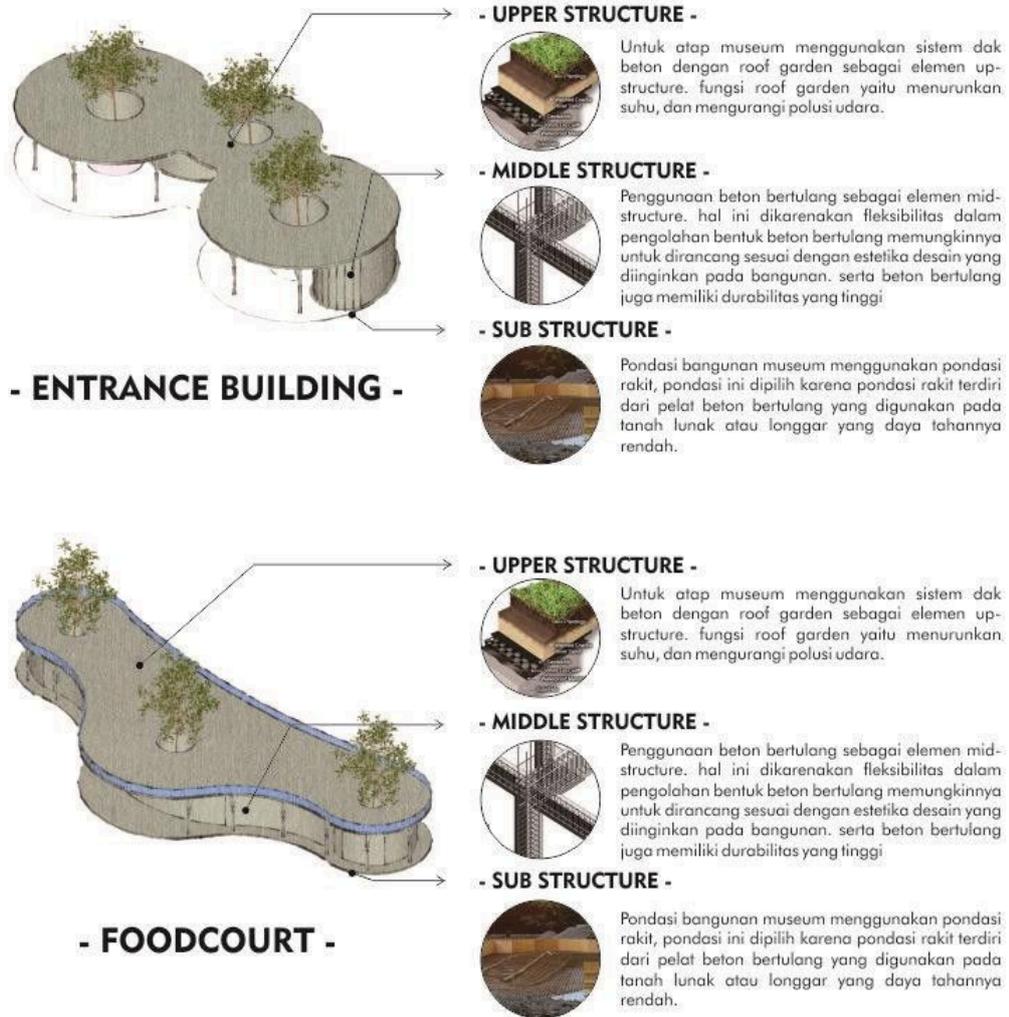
Analisis Struktur Bangunan Wedding Chapel dan Museum
